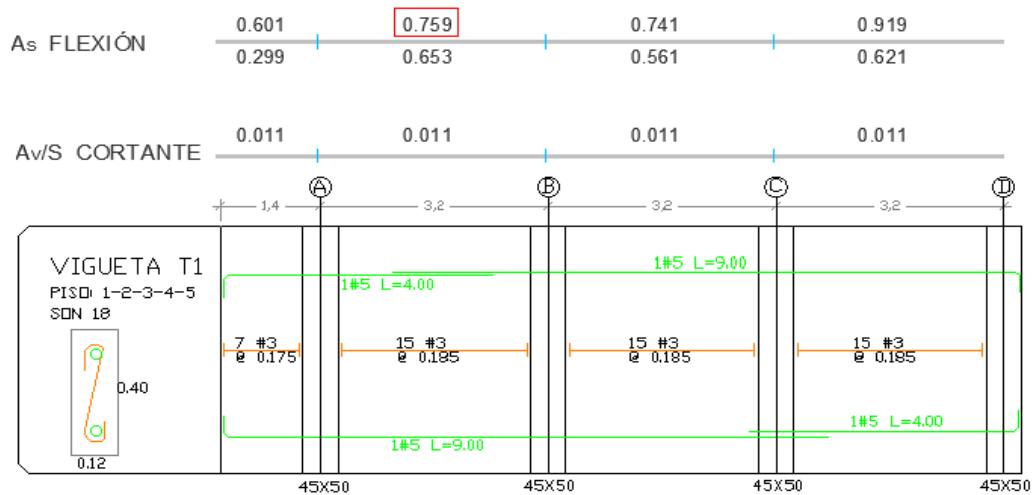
Cuantías obtenidas por esfuerzo a flexión, cortante y despiece de la vigueta tipo 1 de la planta estructural. Fuente: elaboración propia.
